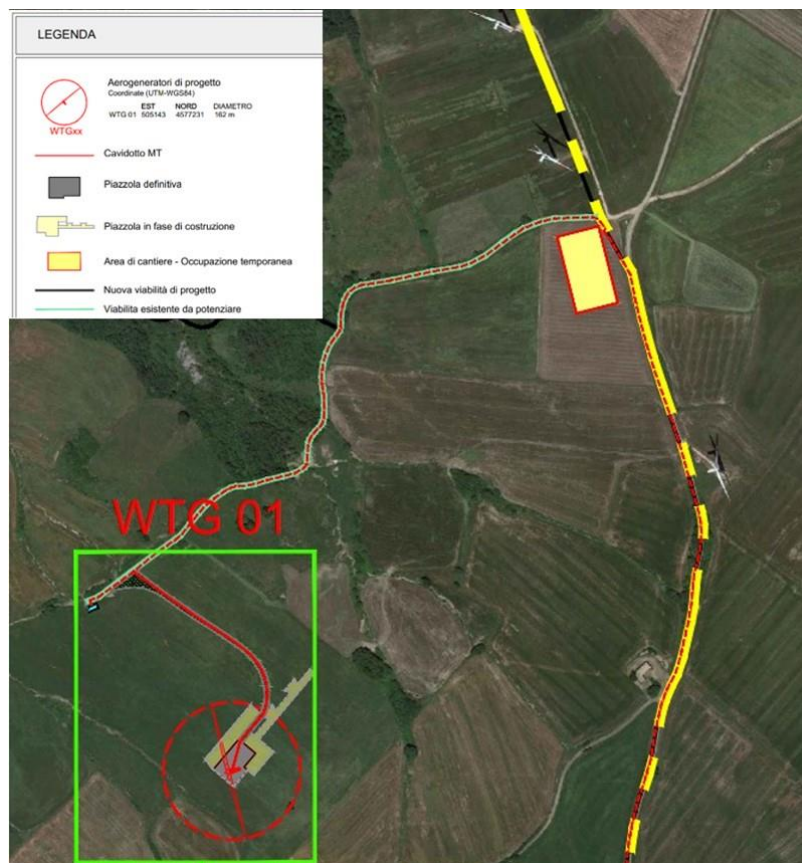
Stralcio WEM_SIA_I.04_Rev_01 con indicazione delle aree di cantiere
